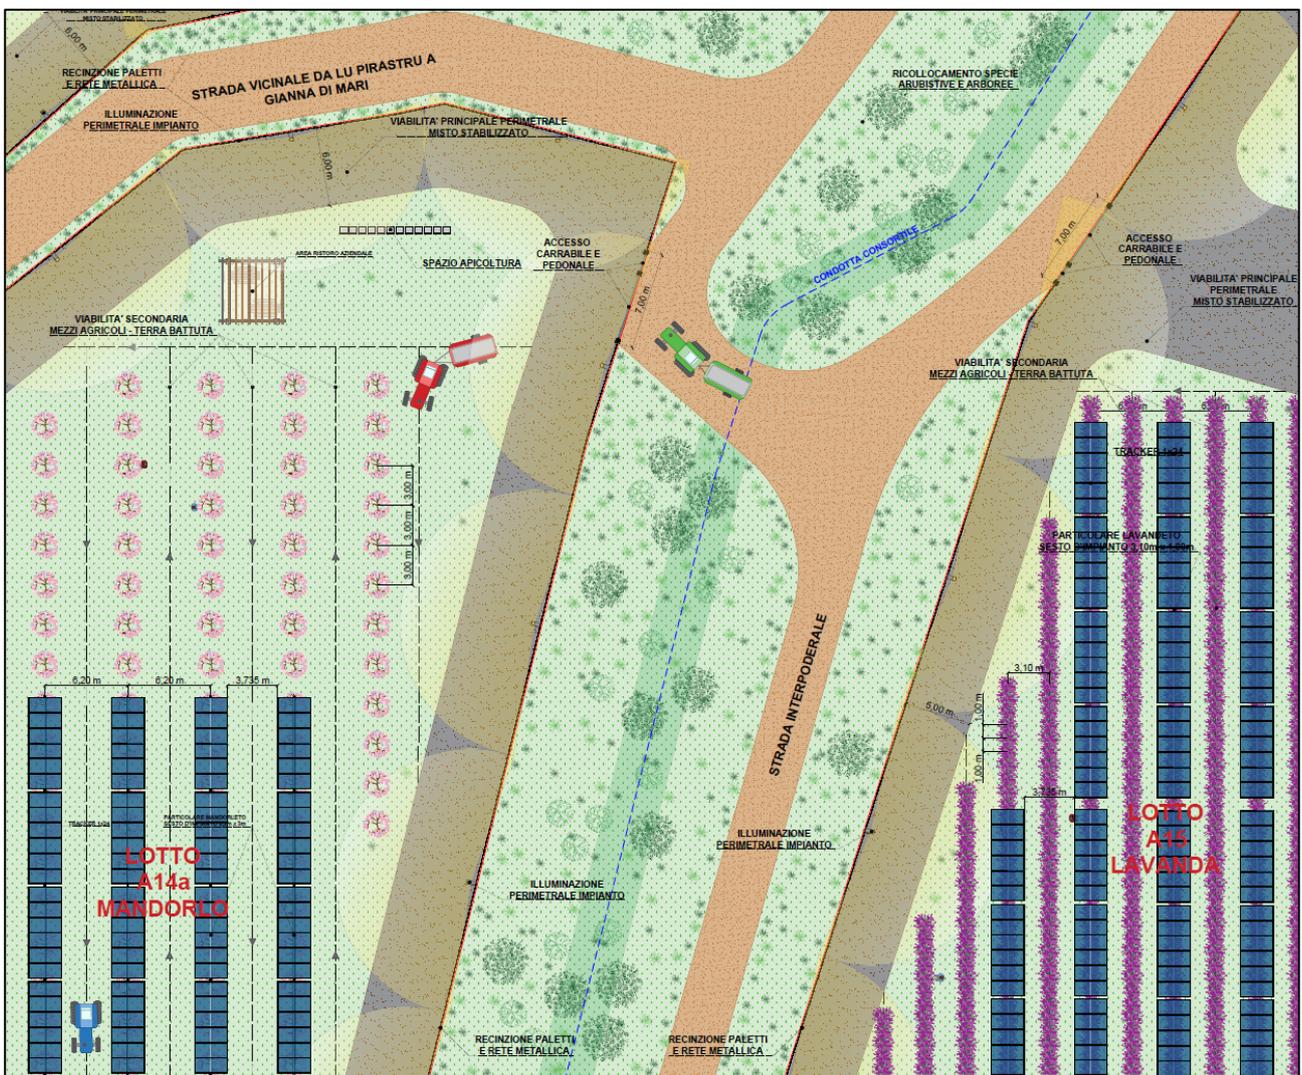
Stralcio planimetria di dettaglio impianto agrivoltaico con evidenza del sistema viario interno e dell'integrazione tra sistema agricolo e sistema fotovoltaico Riferimento Elaborato Grafico "2202_T.P.11_Stralcio planimetria di dettaglio impianto agrivoltaico_Rev00"
